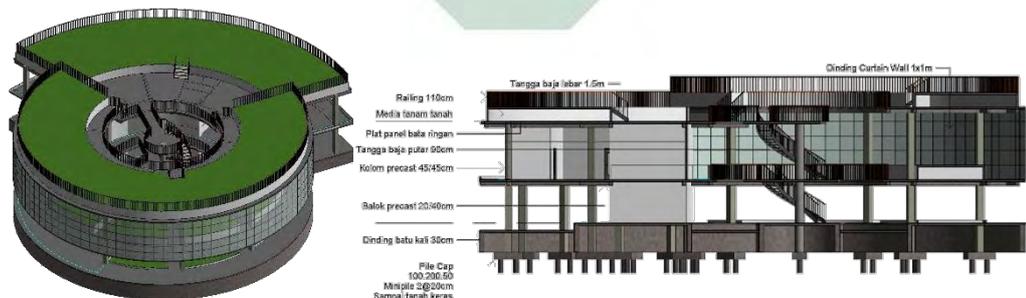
Detail Gedung Riset Tanaman Pangan
